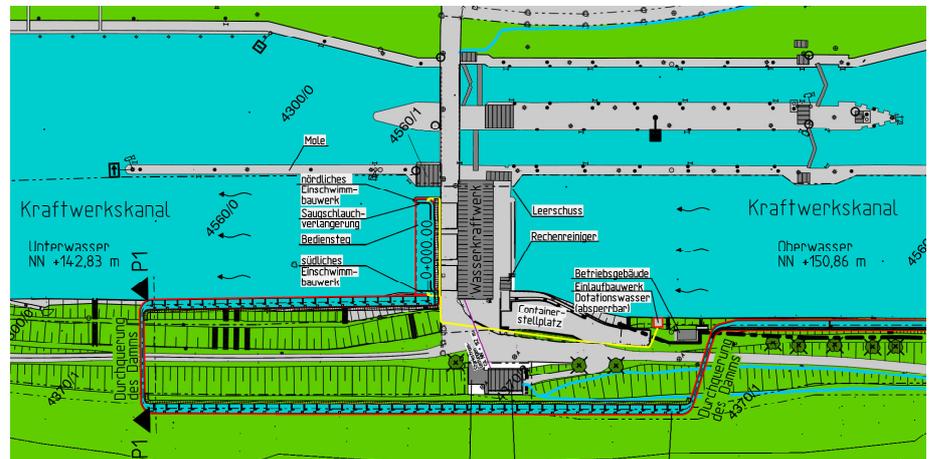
Planausschnitt Lageplan Variante 4 – Vorplanung (Stand Oktober 2011)
